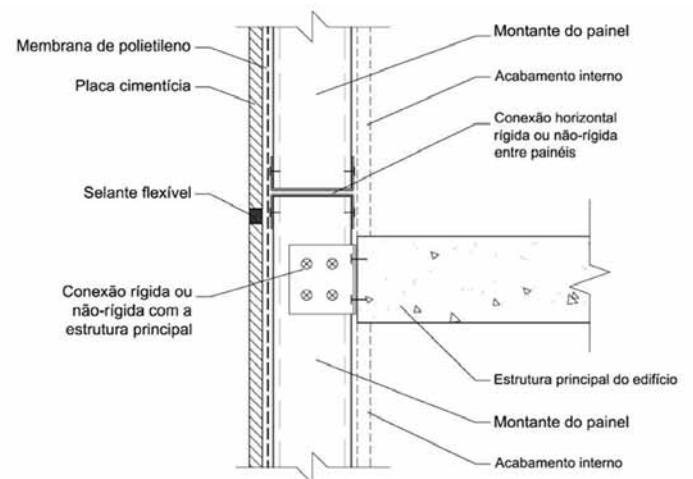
Junta horizontal flexível em placas cimentícias – montagem contínua / Fonte: Adaptado de LGSEA, 2004
